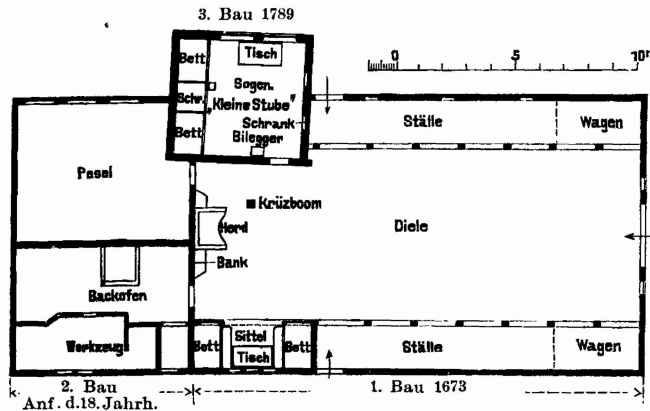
Grundriss des Heldtschen Hauses.
